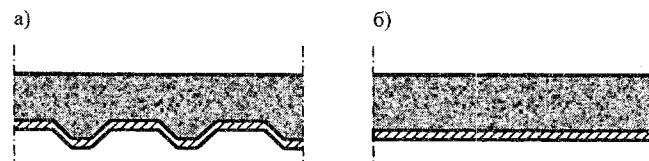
Поперечні перерізи сталезалізобетонних плит:
